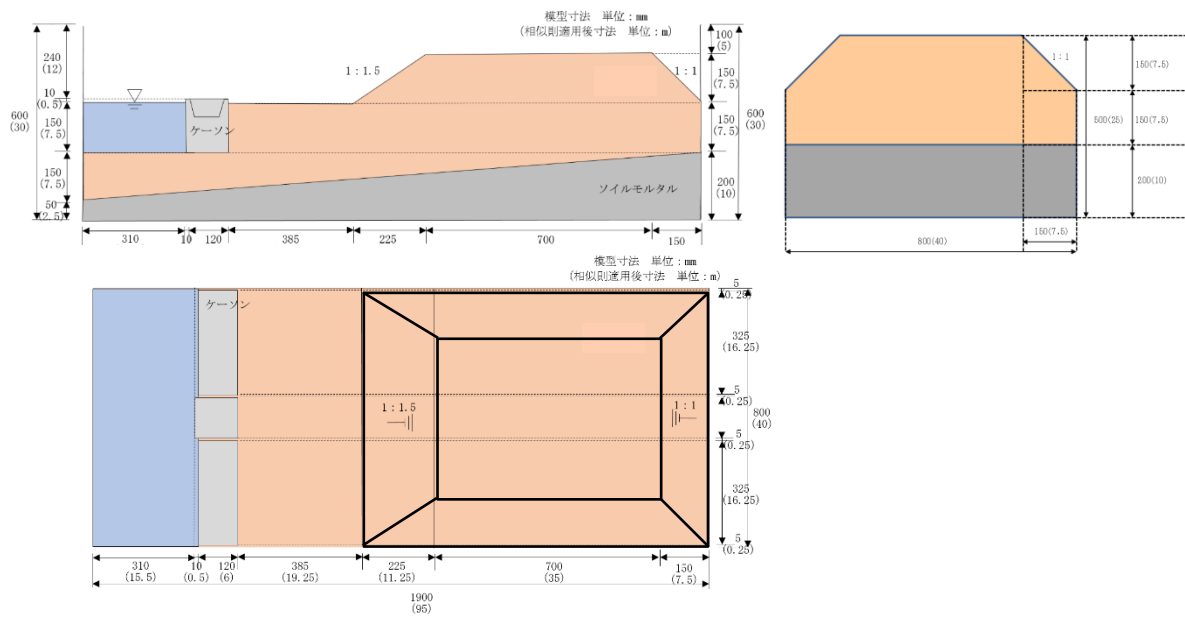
模型地盤(上:断面図, 下:平面図, 右:側面図)
